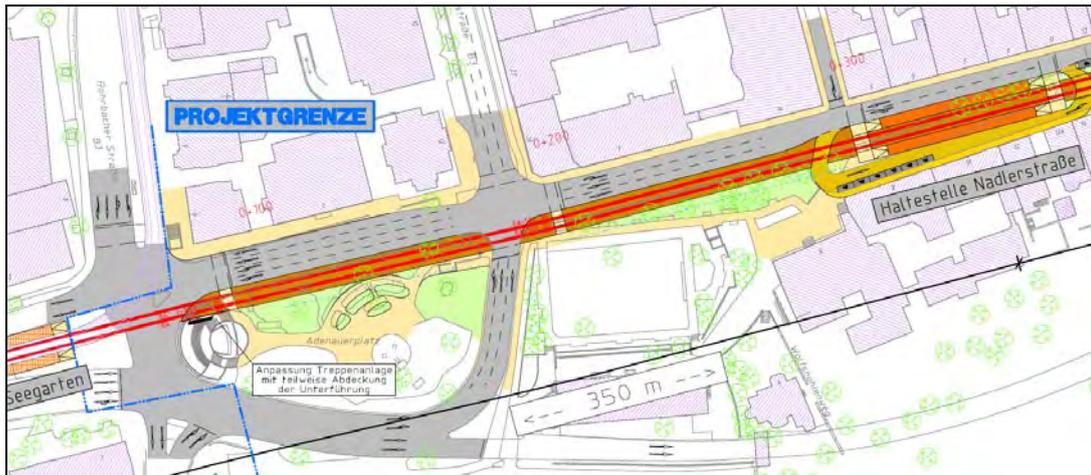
Lageplanausschnitt Adenauerplatz bis Haltestelle Nadlerstraße (Variante 1A)
